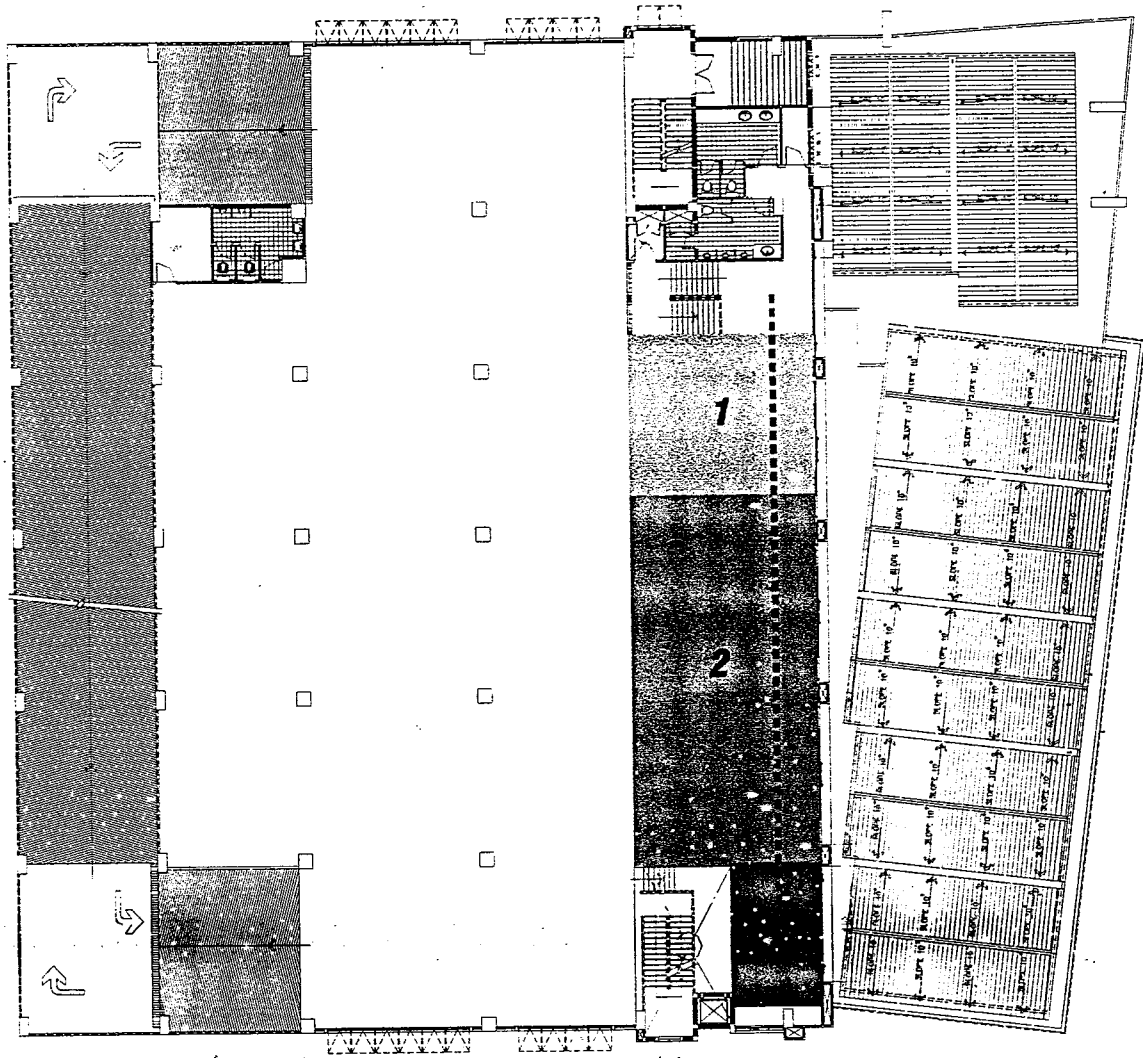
แสดง ZONING FLOOR 3
